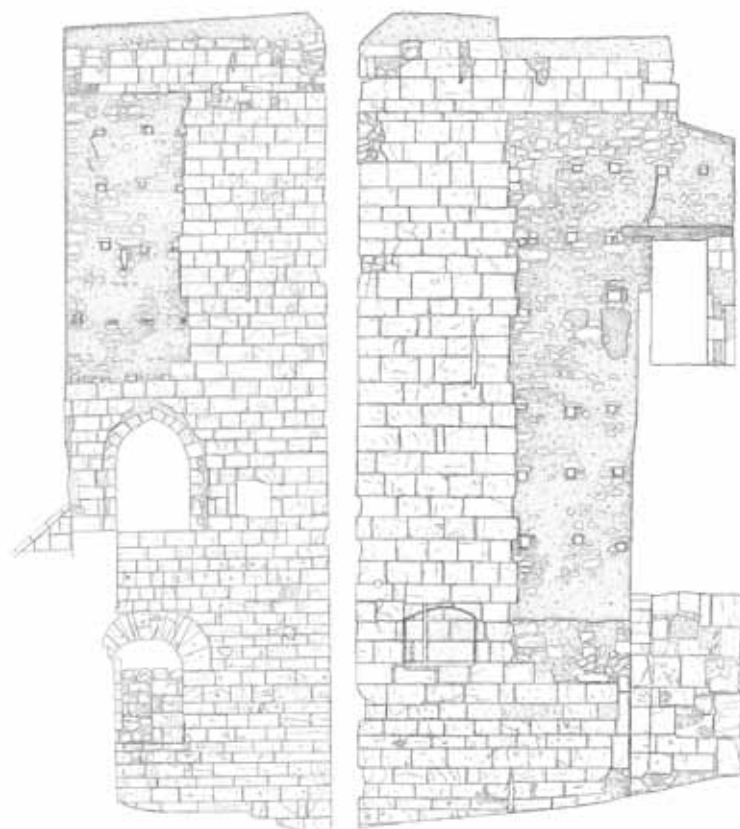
Alzado exterior Torre de Santa Caterina. Izquierda: Levantamiento Sur. Derecha: Levantamiento Norte. Dibujo técnico Silvia Yus Cecilia. Los dibujos fueron realizados durante la ejecución de la obra, cuando se habían picado los revestimientos que cubrían los tapias, quedando al descubierto las improntas de la técnica constructiva.
